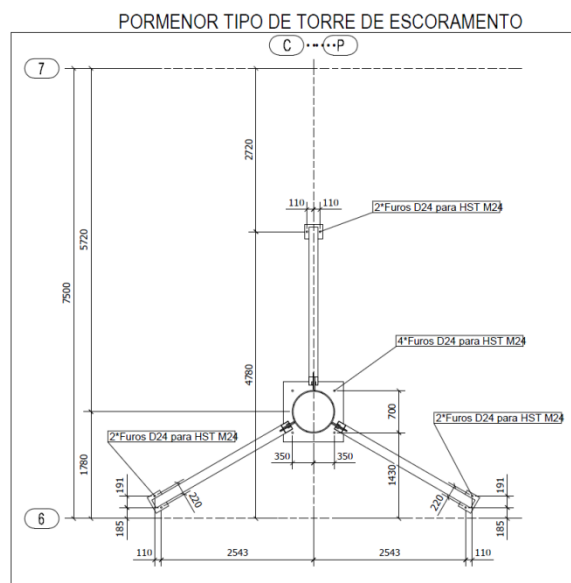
Pormenor da torre de escoramento de apoio à montagem
